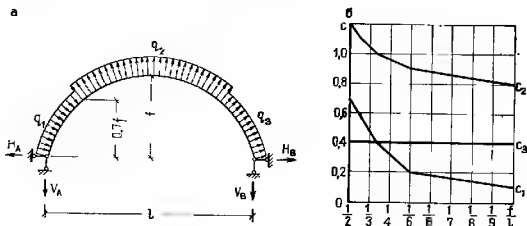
Ветровая нагрузка на сводчатое покрытие
